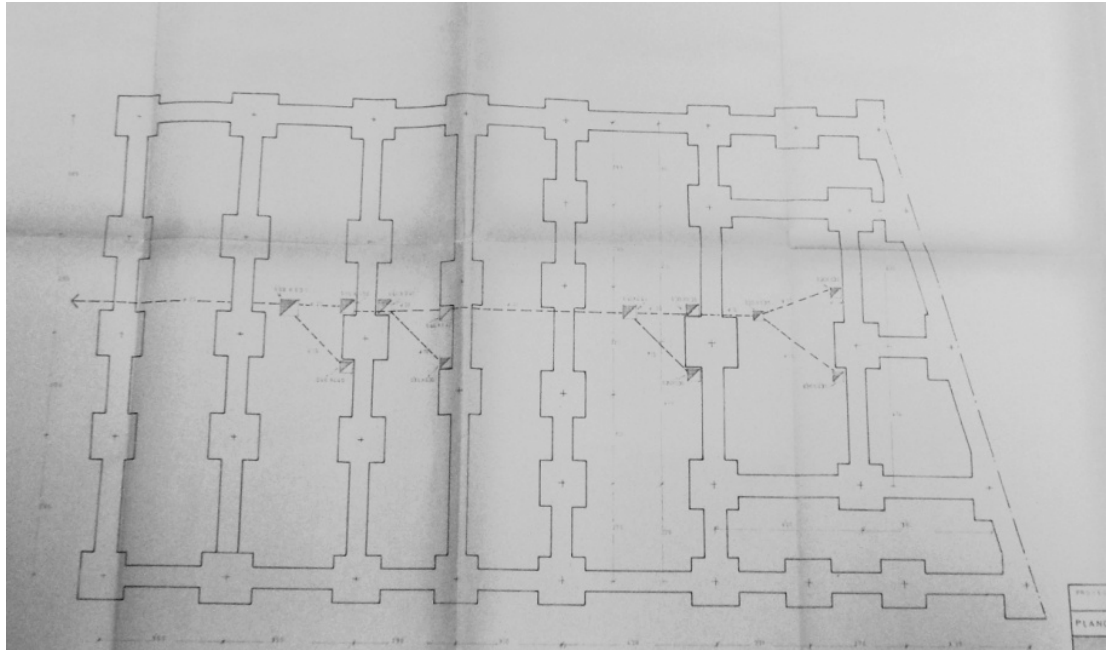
Planta de cimentación del edificio situado en la Av. de la Salud
